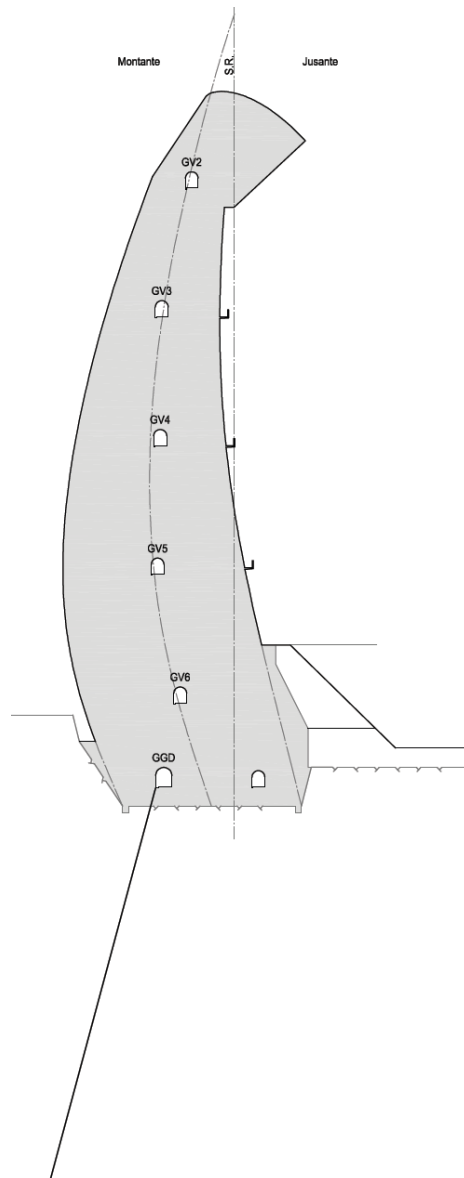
Pormenor tipo de um perfil fictício de furação de impermeabilização
